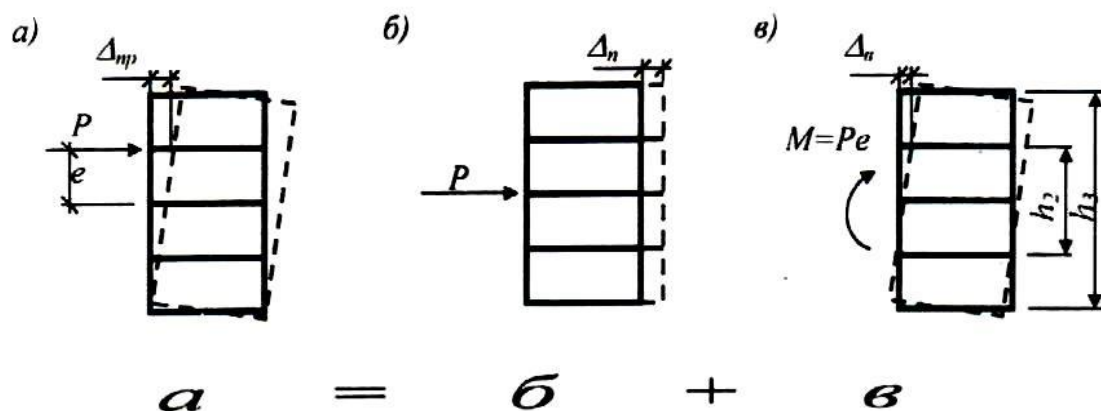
Схема перемещений верхних концов колонн каркаса при жесткой кровле.
